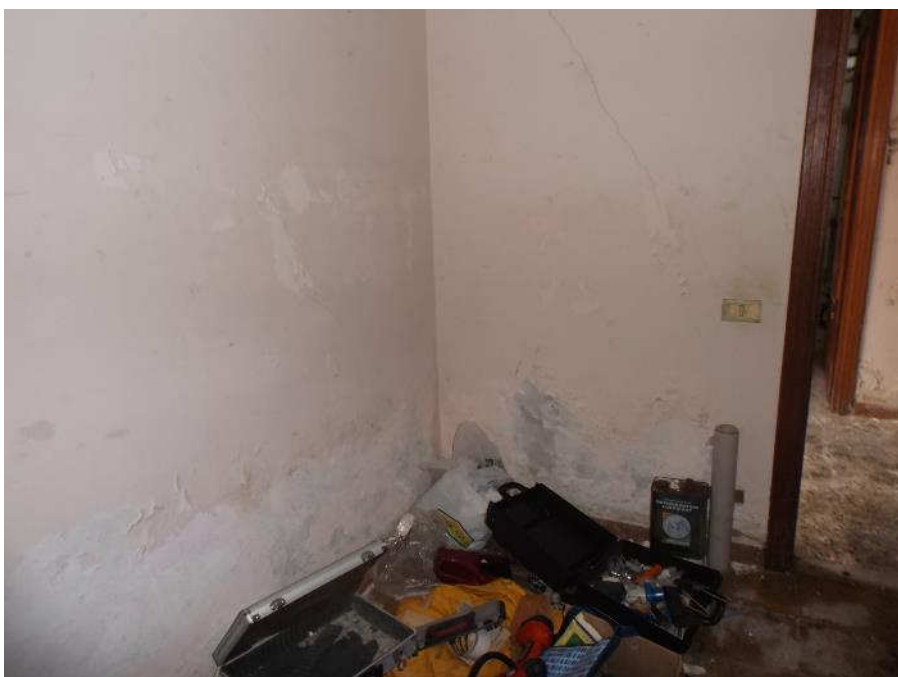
Piano terra - Particolare presenza macchie di umidità di risalita nel vano n° 1
